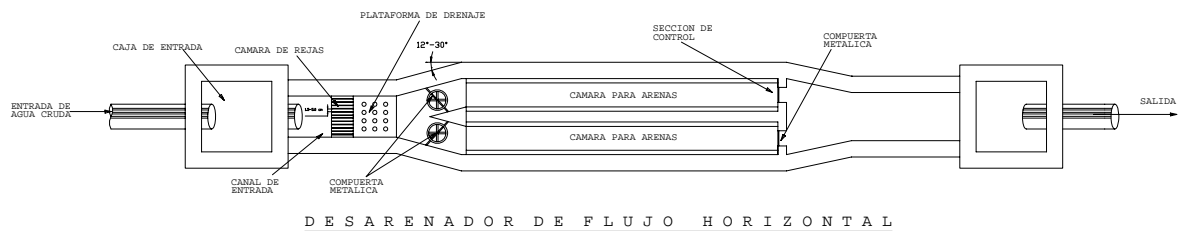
Desarenador de 2 unidades en paralelo (planta).
